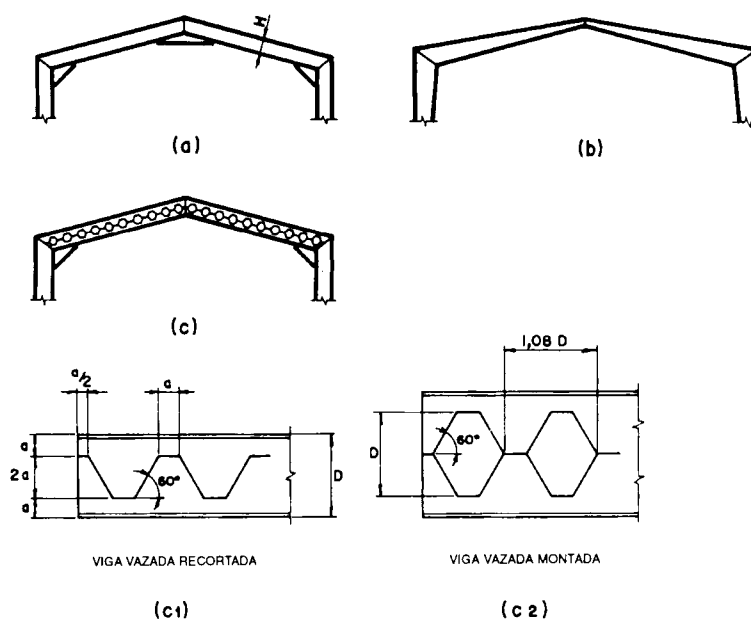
Tipos de viga de cobertura em alma cheia
